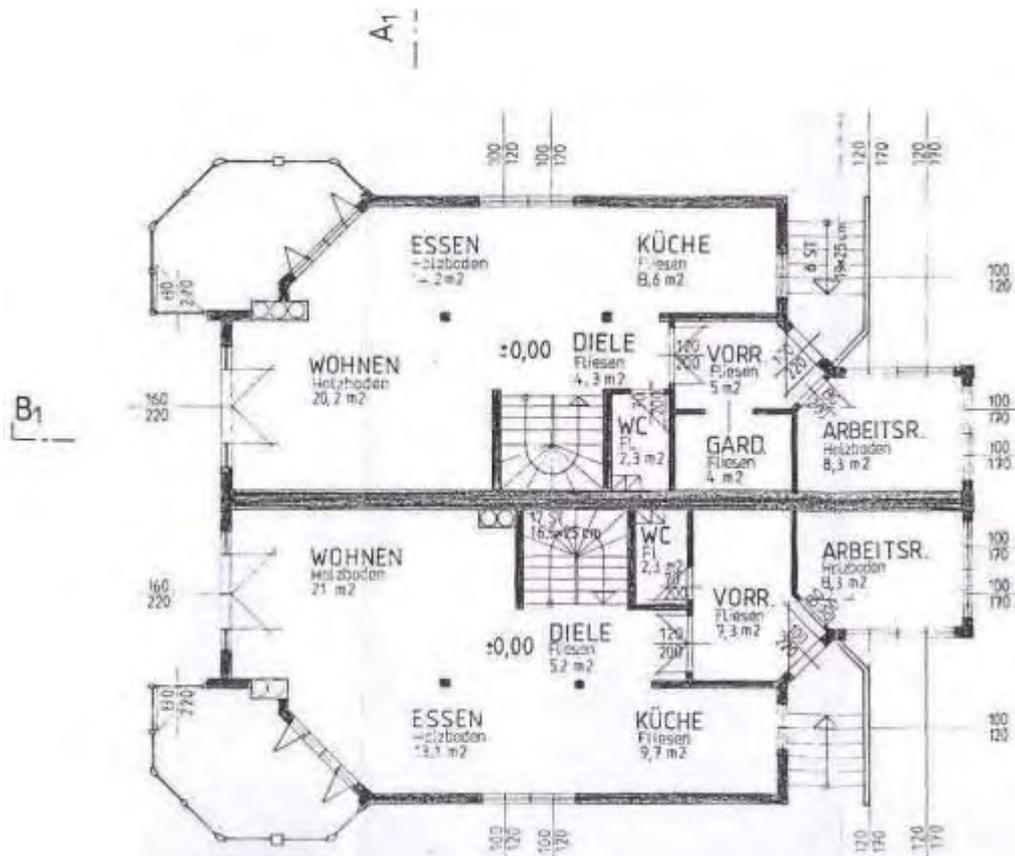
Grundriss Erdgeschoß „Haus K.“
